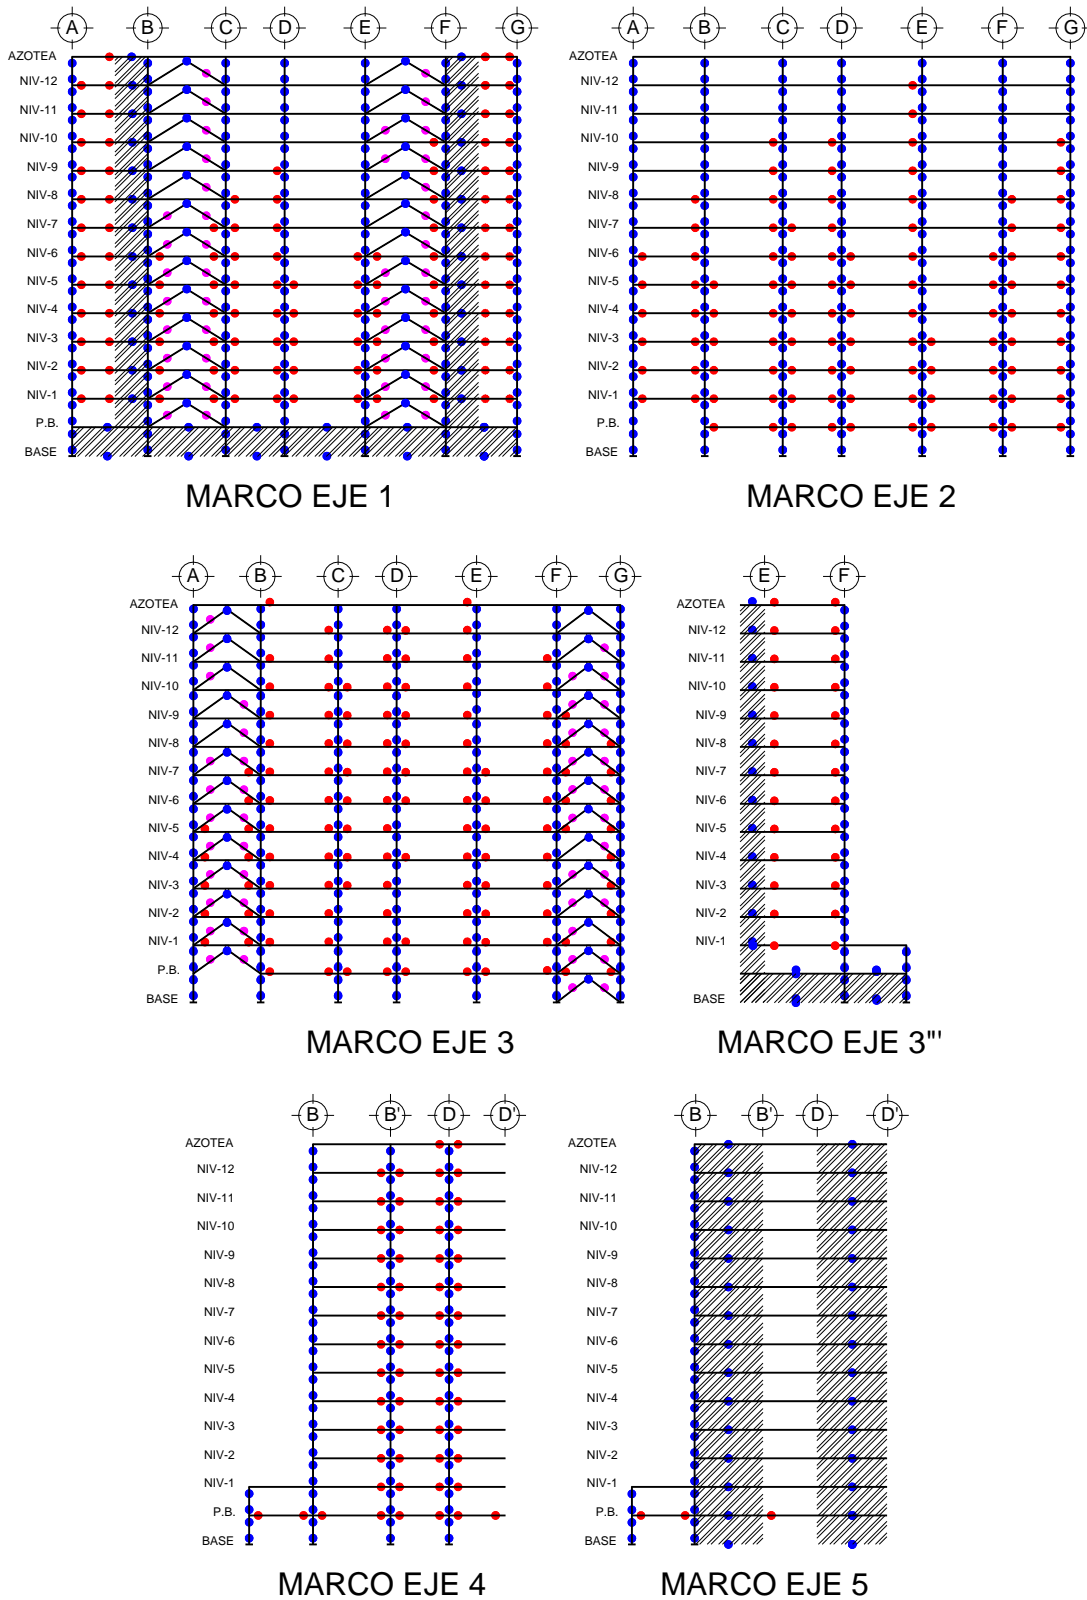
Articulaciones plásticas en la estructura, marcos longitudinales.
